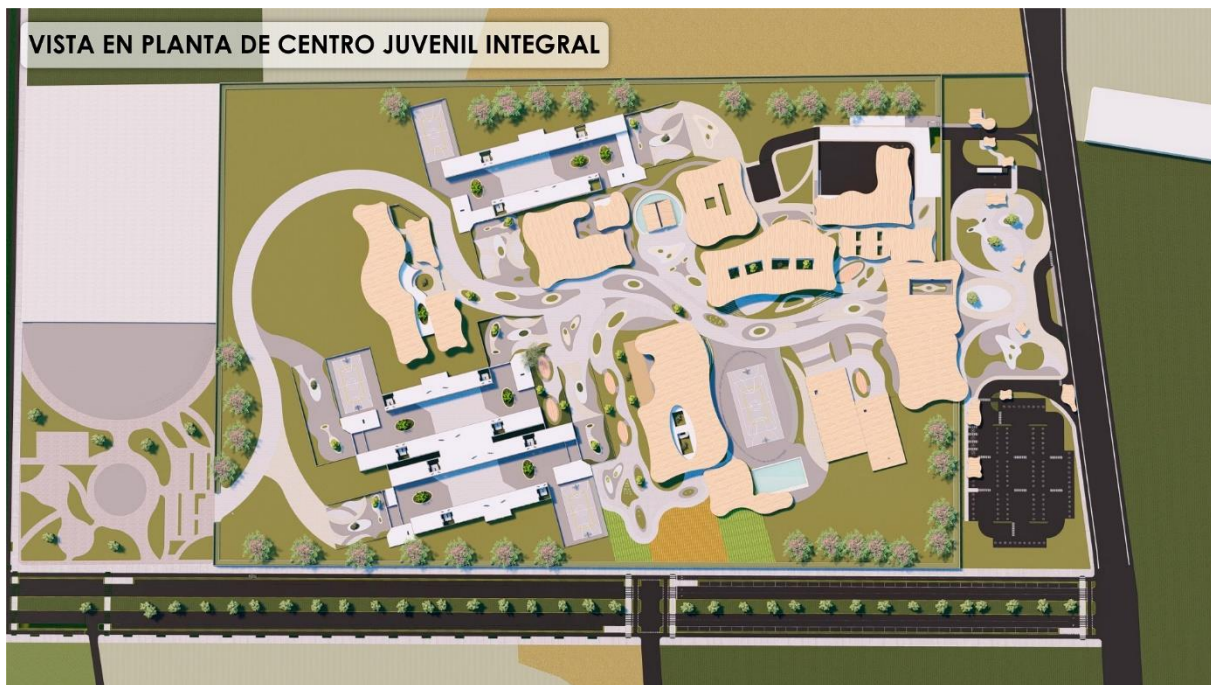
Vista en planta del Centro Juvenil Integral / Edición: Propia
